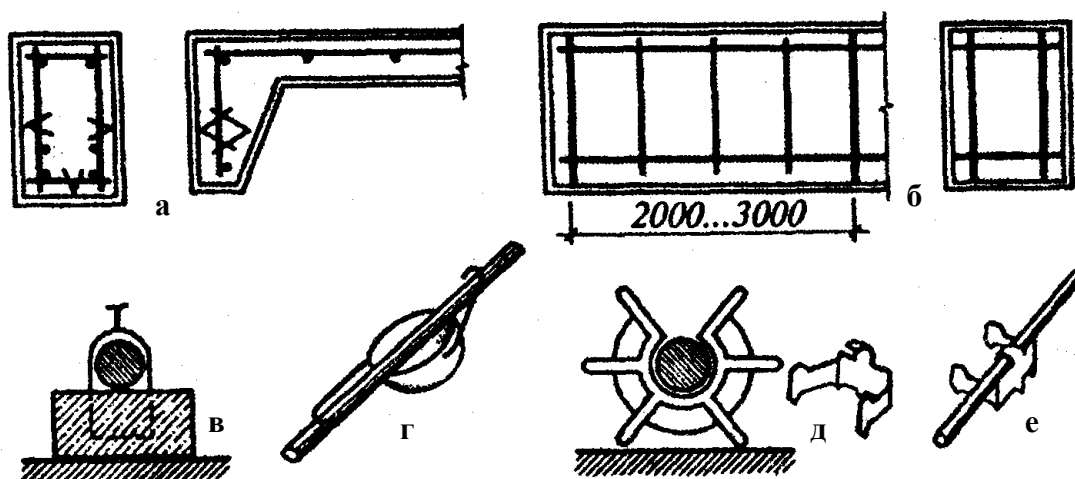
Способи забезпечення захисного шару арматури: а – в балках і ребрах плит за допомогою упорів; б – в балках за допомогою подовжених стрижнів; в – за допомогою бетонної підкладки з дротяною скруткою; г – за допомогою бетонного корка з пружинною скобою; д – за допомогою пружного пластмасового фіксатора; е – за допомогою металевих штампованих підставок
